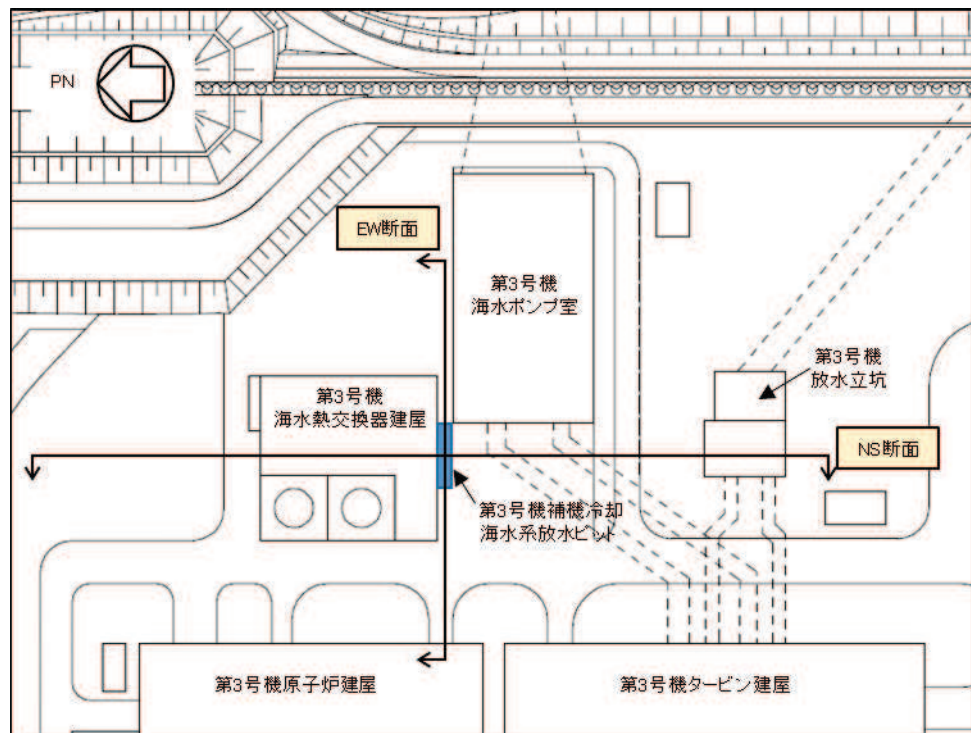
第 3 号機補機冷却海水系放水ピット平面配置図
